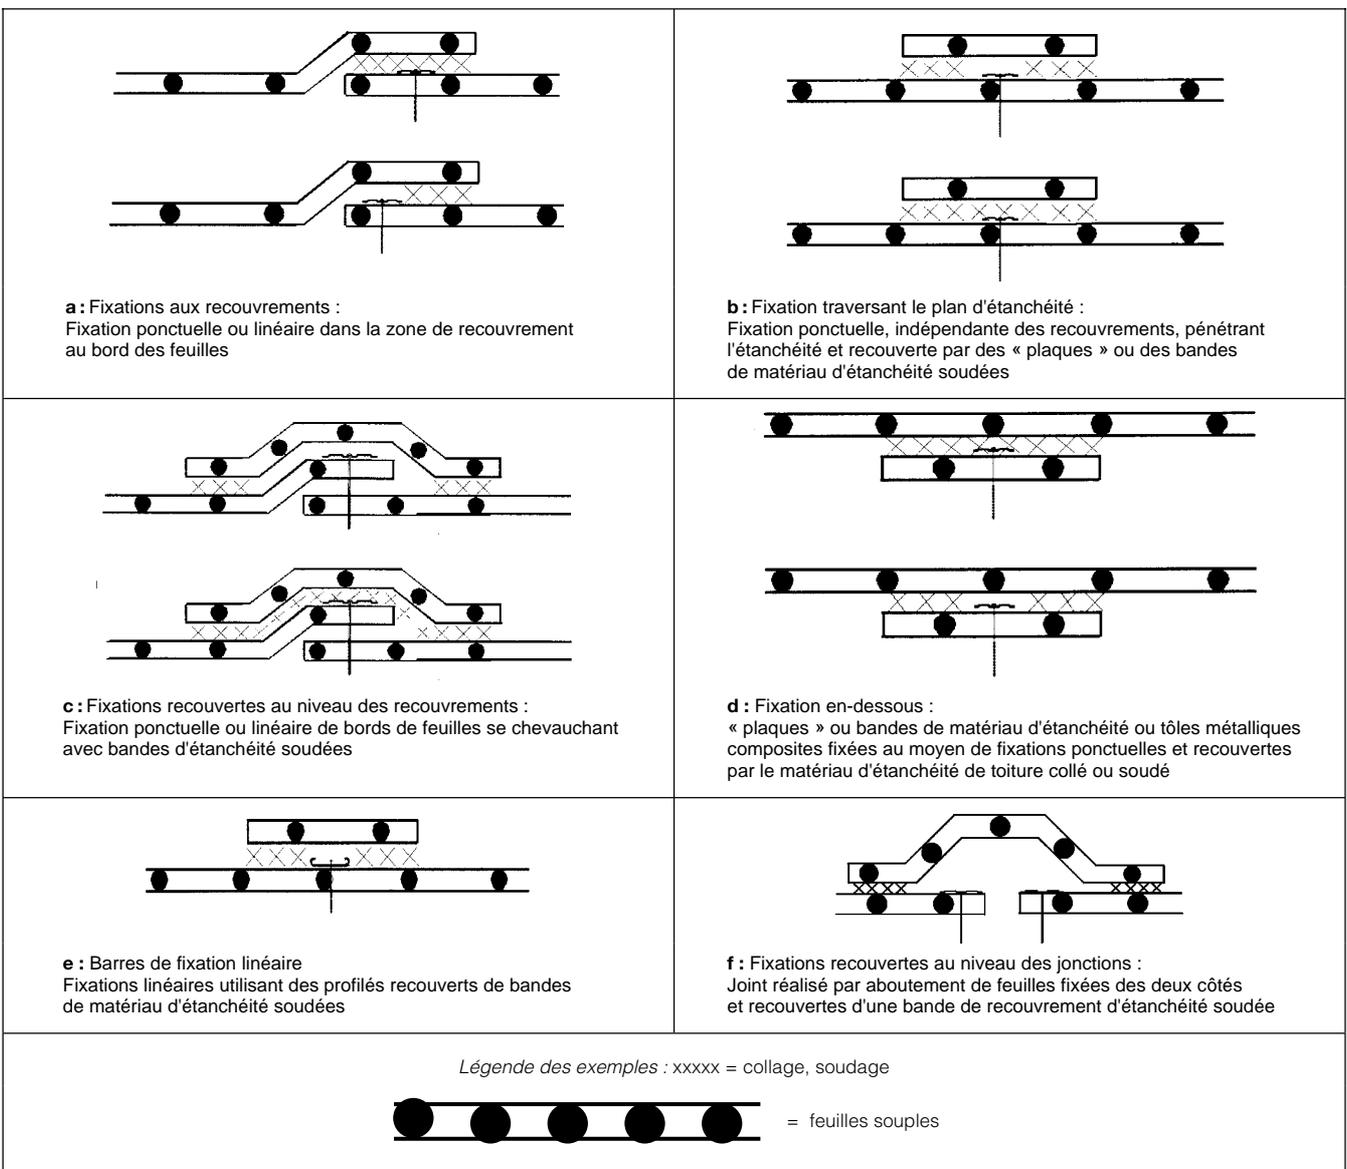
Exemples de feuilles d'étanchéité de toitures fixées mécaniquement
